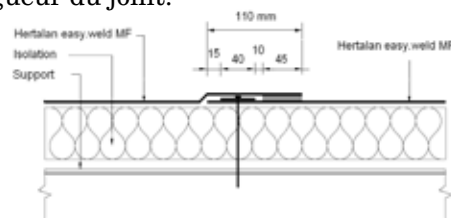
Assemblage par recouvrement longitudinal Hertalan easy.weld MF
